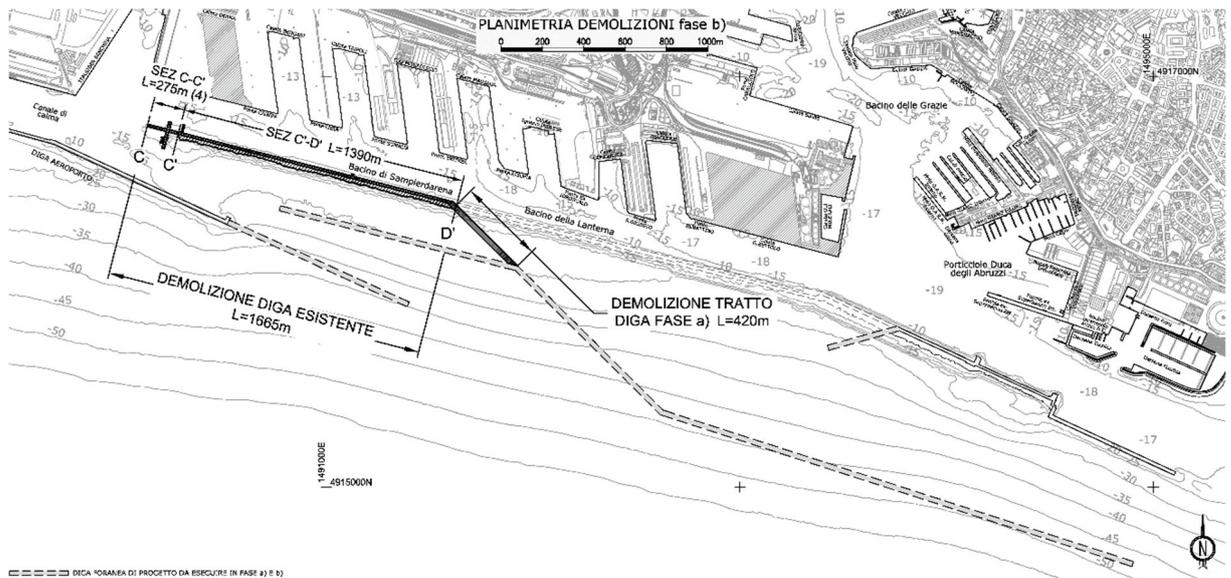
PLANIMETRIA DELLE DEMOLIZIONI PREVISTE IN FASE B)
